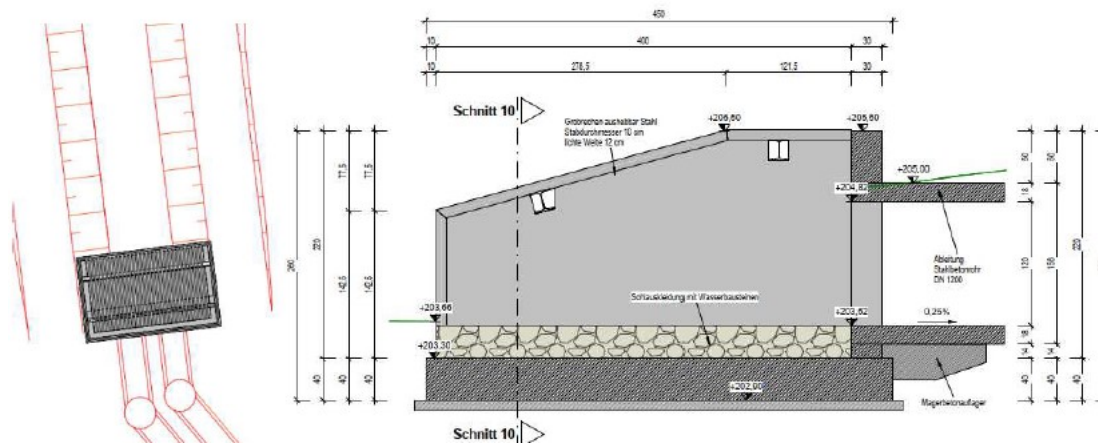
Schematischer Grundriss und Schnitt durch den Rohrkopf ([13], Kap.7.5.5, Abb.48)
